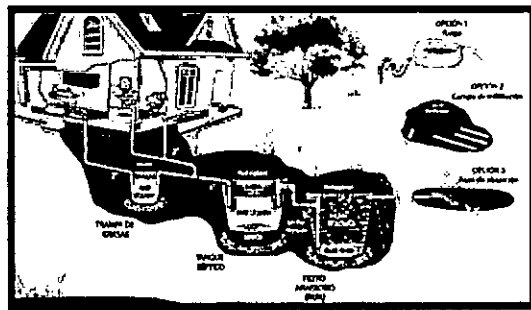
Esquema STARD de Tanque Séptico y Fafa prefabricado.
